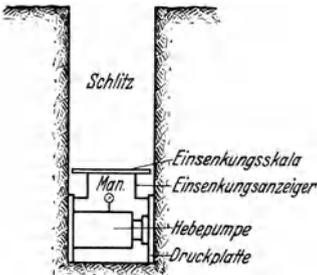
Horizontale Probelastung in einer Schürfgrube mit Hilfe einer hydraulischen Presse.
